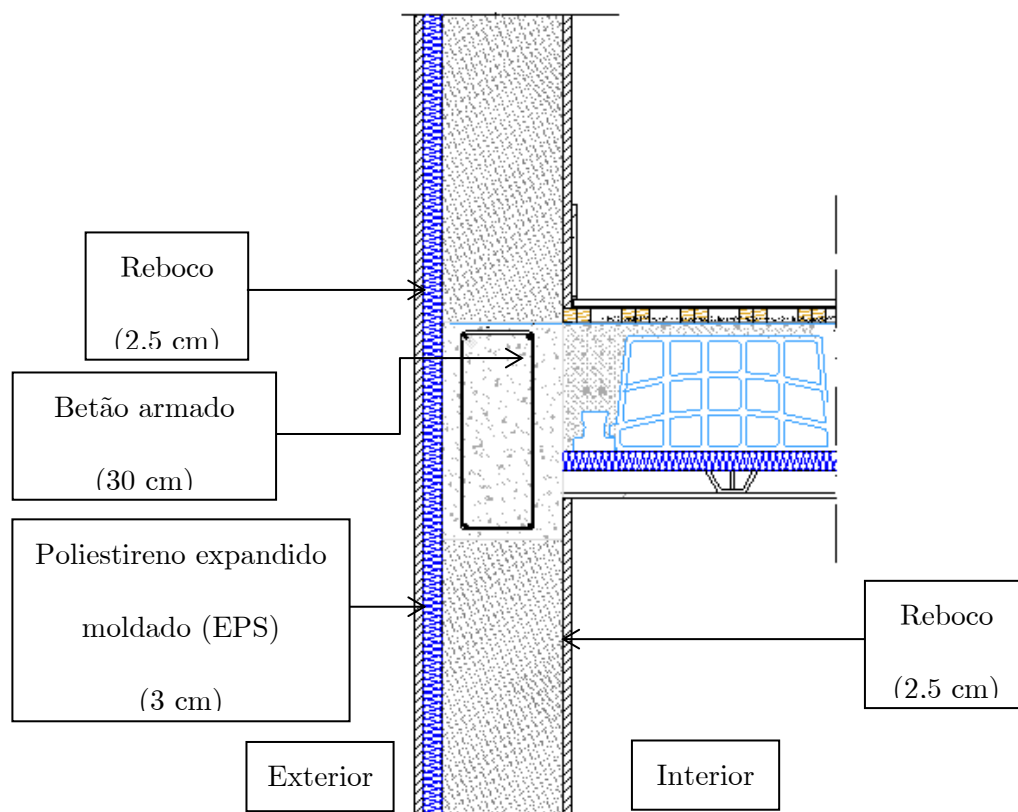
Pormenor construtivo das vigas (N<sub>2</sub>)
